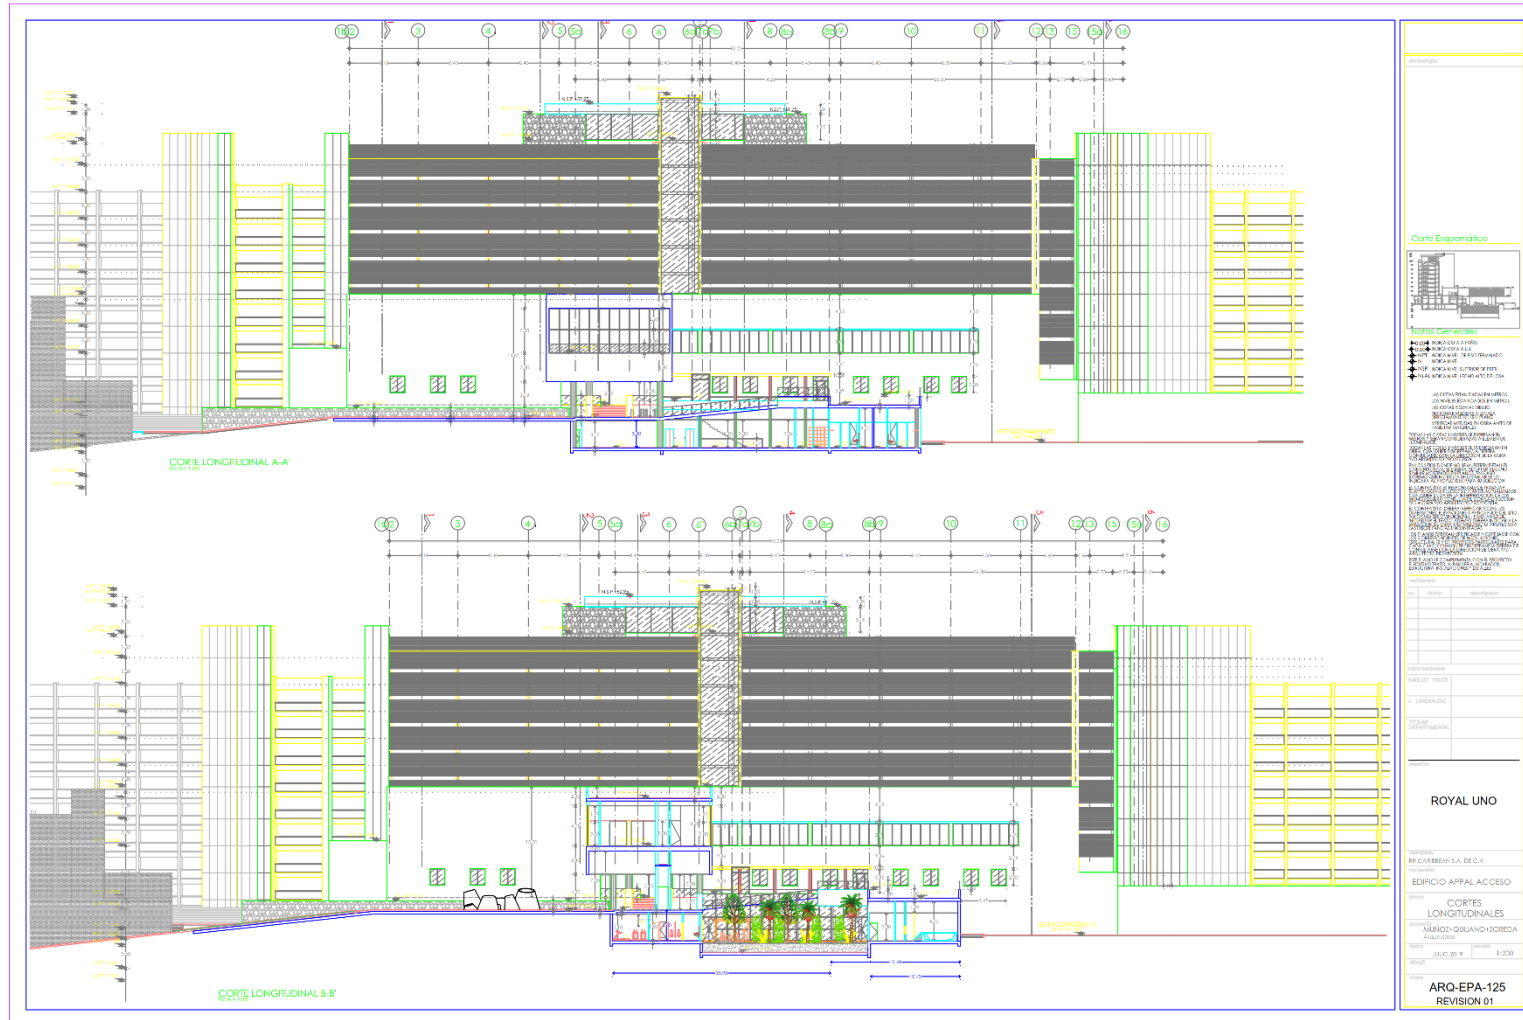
Edificio D y de acceso, Fachada posterior y principal. Anexo C-7.
